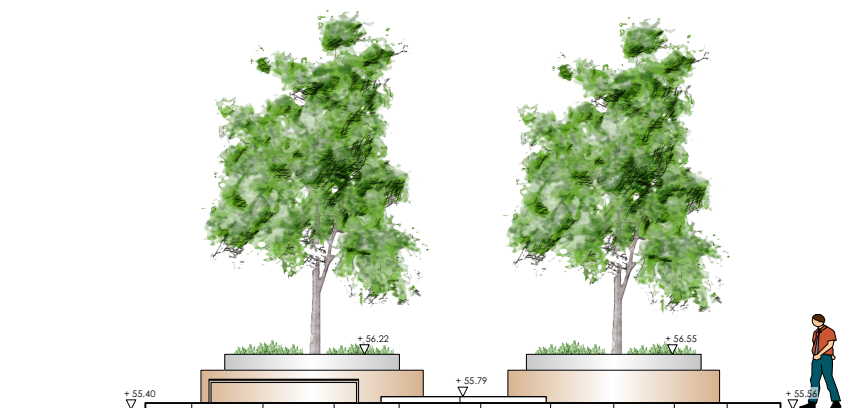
Schnitt - Hochbeetpflanzung mit vorgesetzten Betonringen aus Cortenstahl
